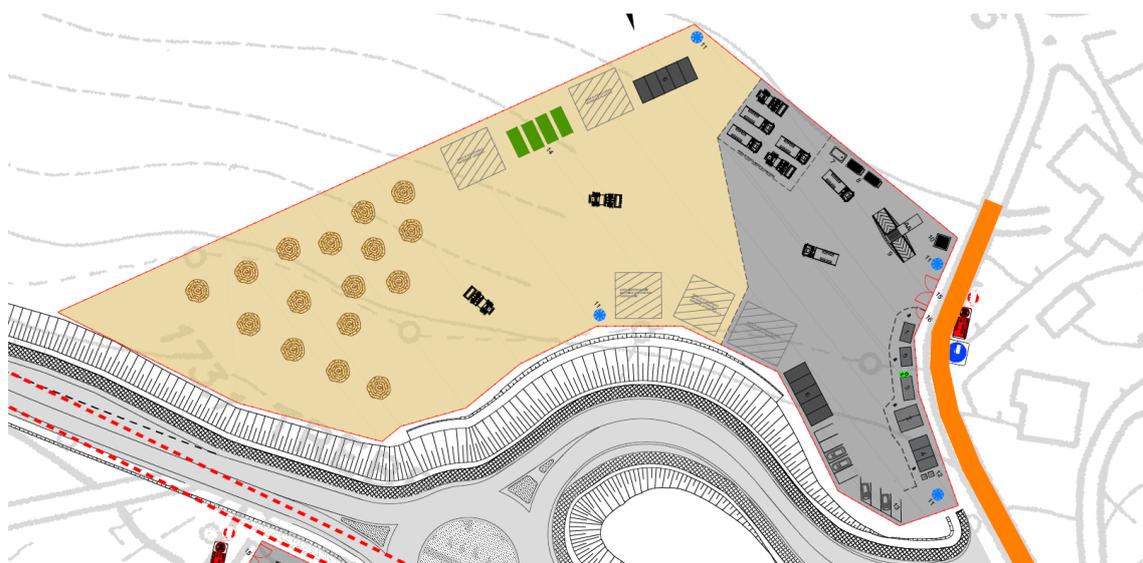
AREA CANTIERE DI SERVIZIO SC1
